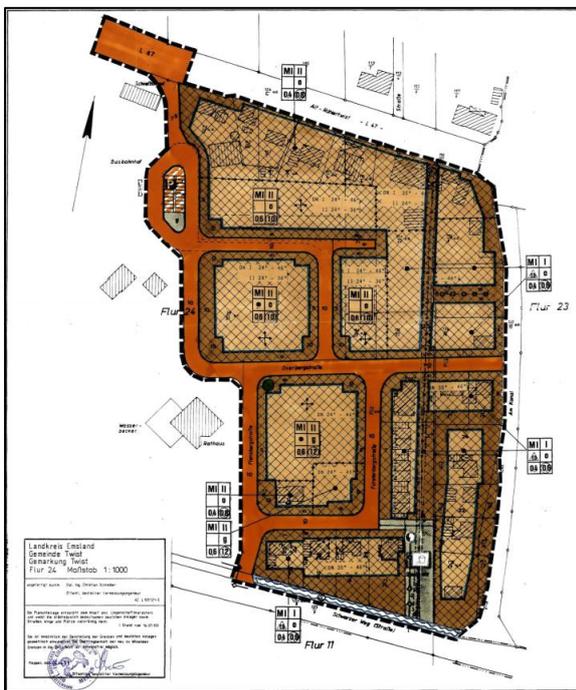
Planzeichnung der 5. Änderung des B-Planes Nr. 14
